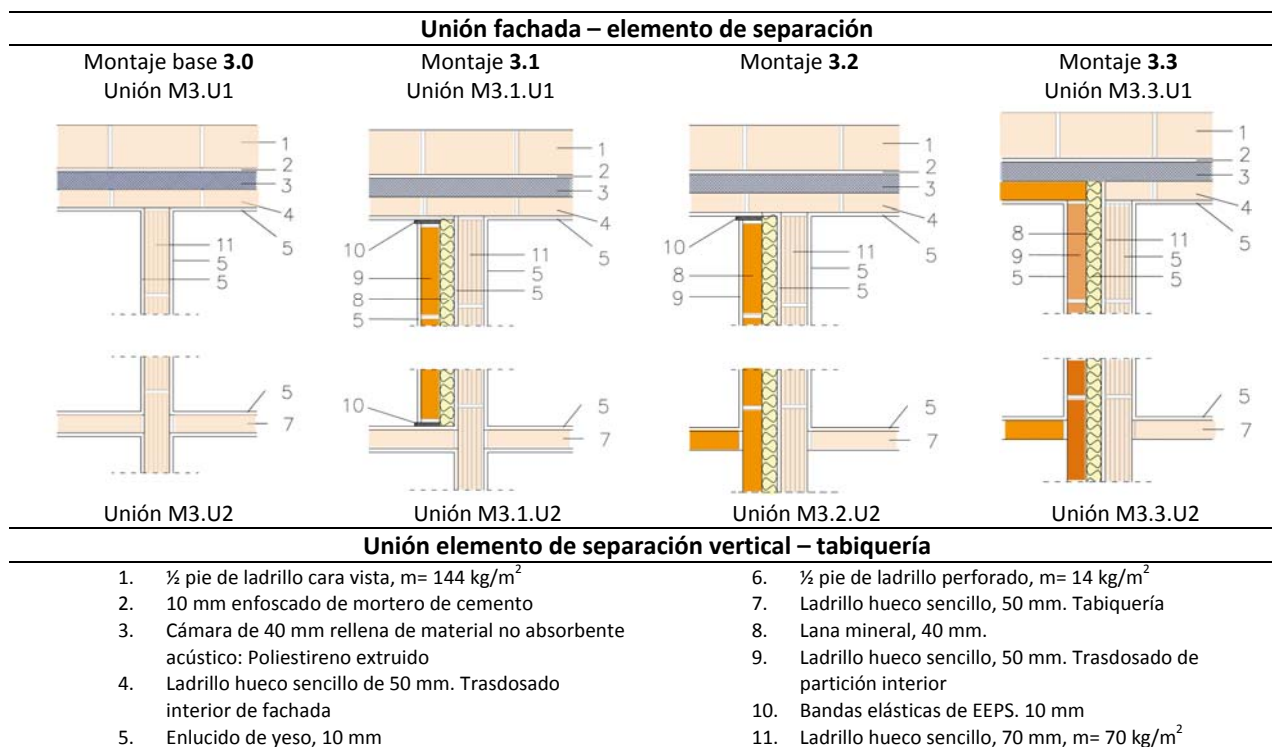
Serie de montajes 3. Sección horizontal por fachada y tabique. Codificación de las uniones ensayadas
